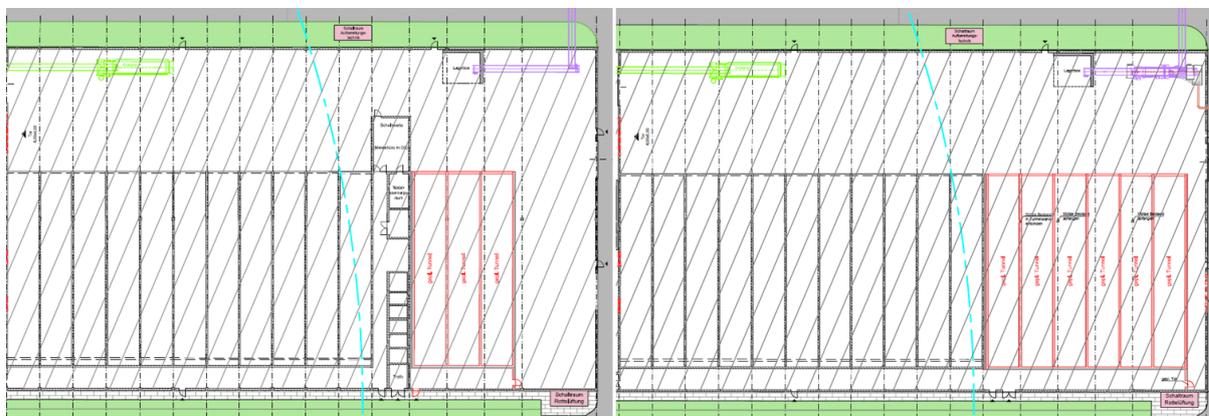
Links: Ausschnitt Lageplan Standortlayout V1; rechts: Ausschnitt Lageplan Standortlayout V2
